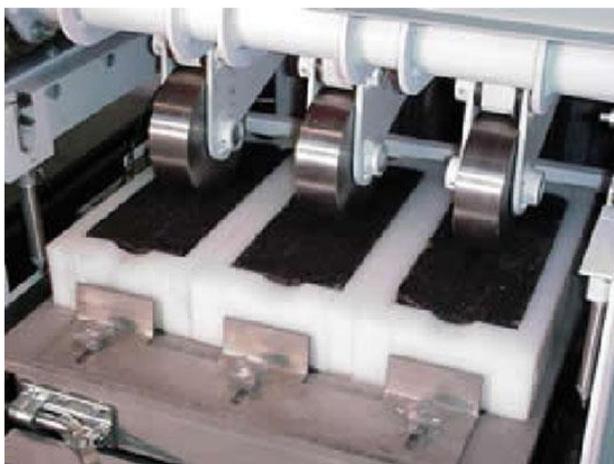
L'essai Asphalt Pavement Analyzer (APA) (AASHTO 340-10)
